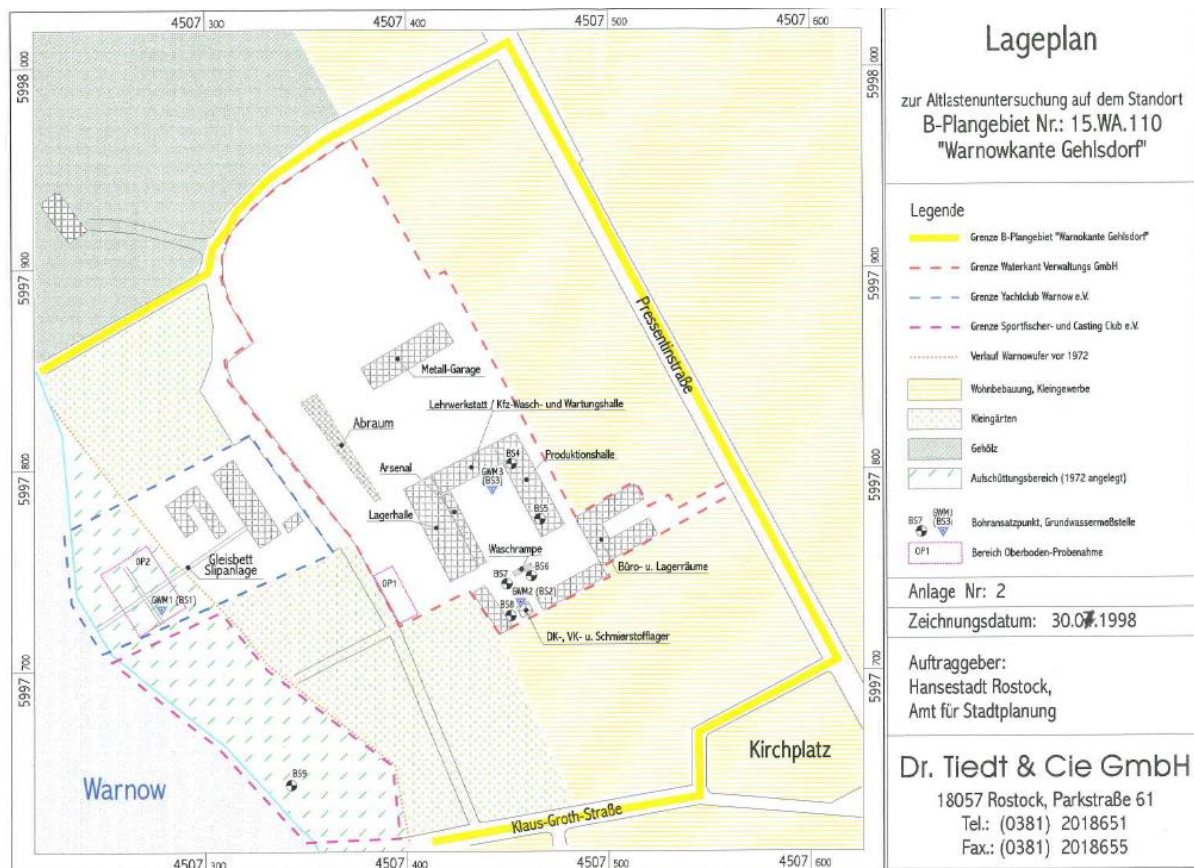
Lageplan mit Bohransatzpunkten und Grundwassermessstellen
